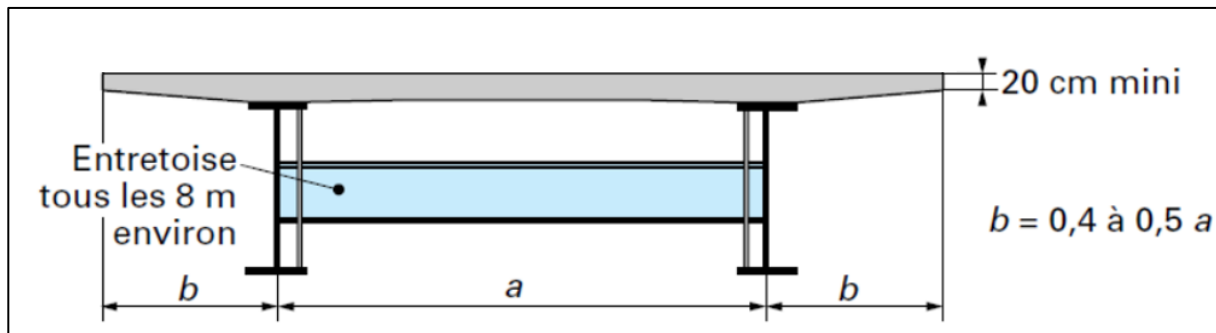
Coupe transversale d'un tablier bipoutre.
